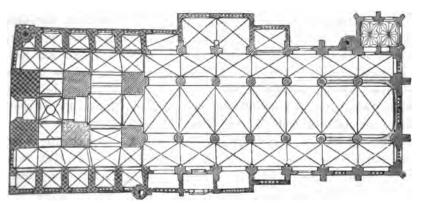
Jacobi-Kirche. Grundriss. 1:667.
